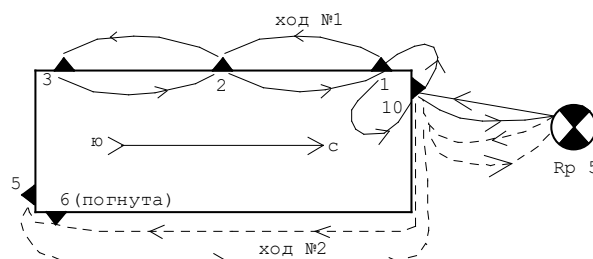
Схема нивелирных ходов по периметру наружных стен монолитного фундамента
